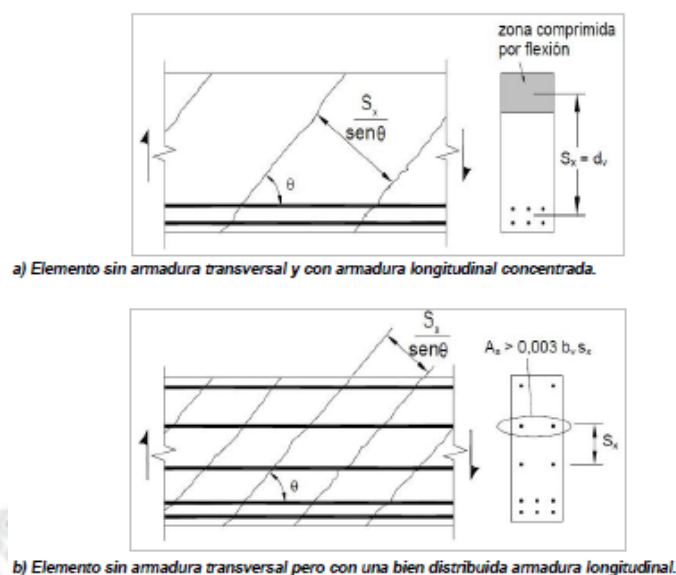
Definición del parámetro de separación de las fisuras, s_x (Fuente: Fig.5.8.3.4.2-1 AASHTO 2014[3])
